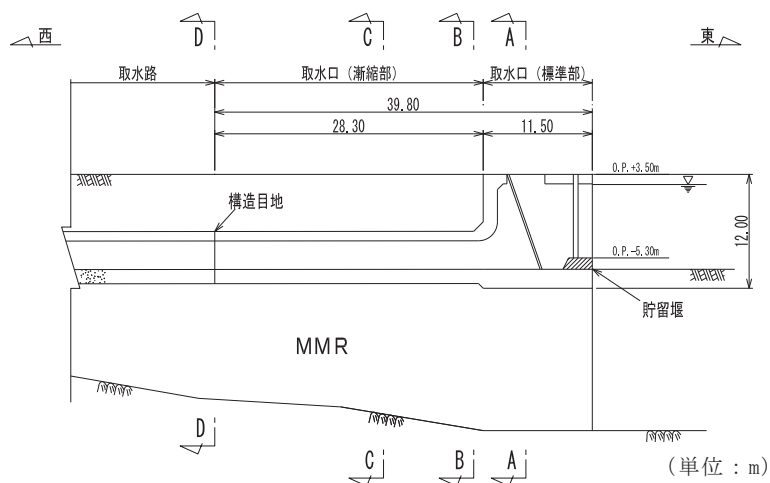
取水口縦断面図 (E-E 断面, 東西)
